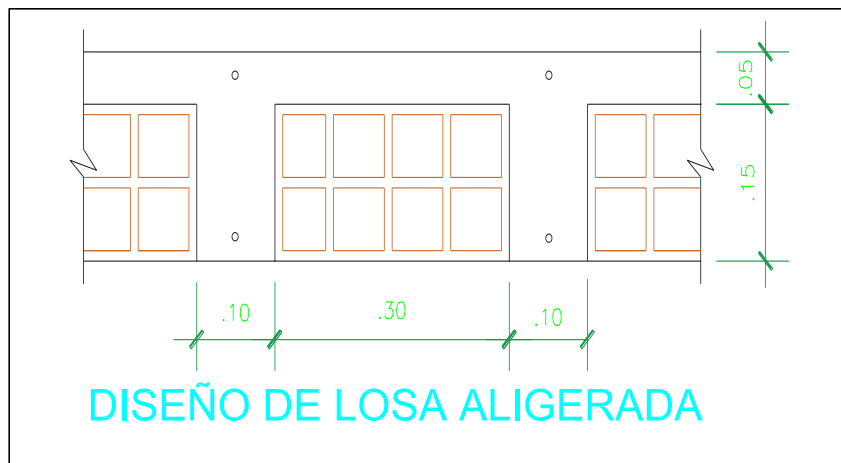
Diseño de Losa Aligerada – Albañilería confinada
